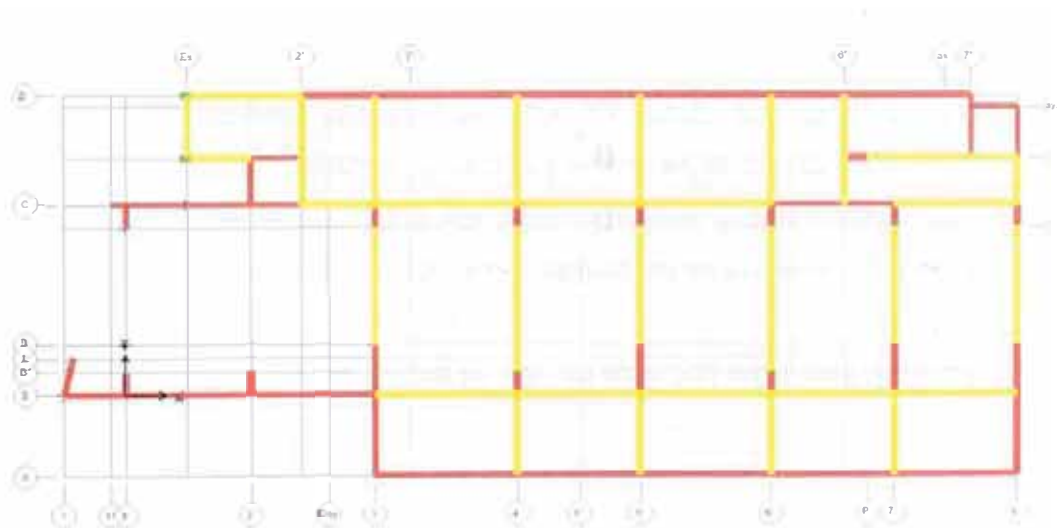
Distribución en planta de muros, vigas y columnas del Primer Nivel
